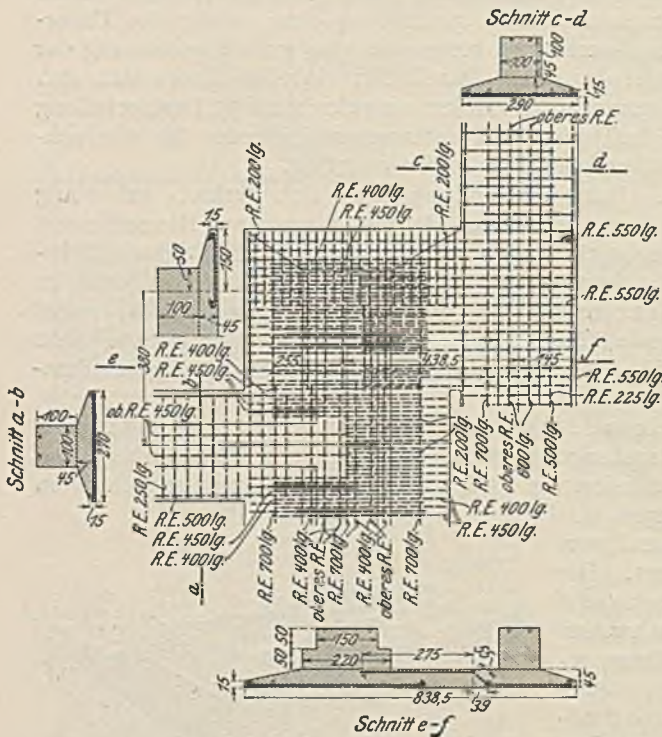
a bis e. Beispiel für eine Gründung auf Plattenrost aus Eisenbeton.
